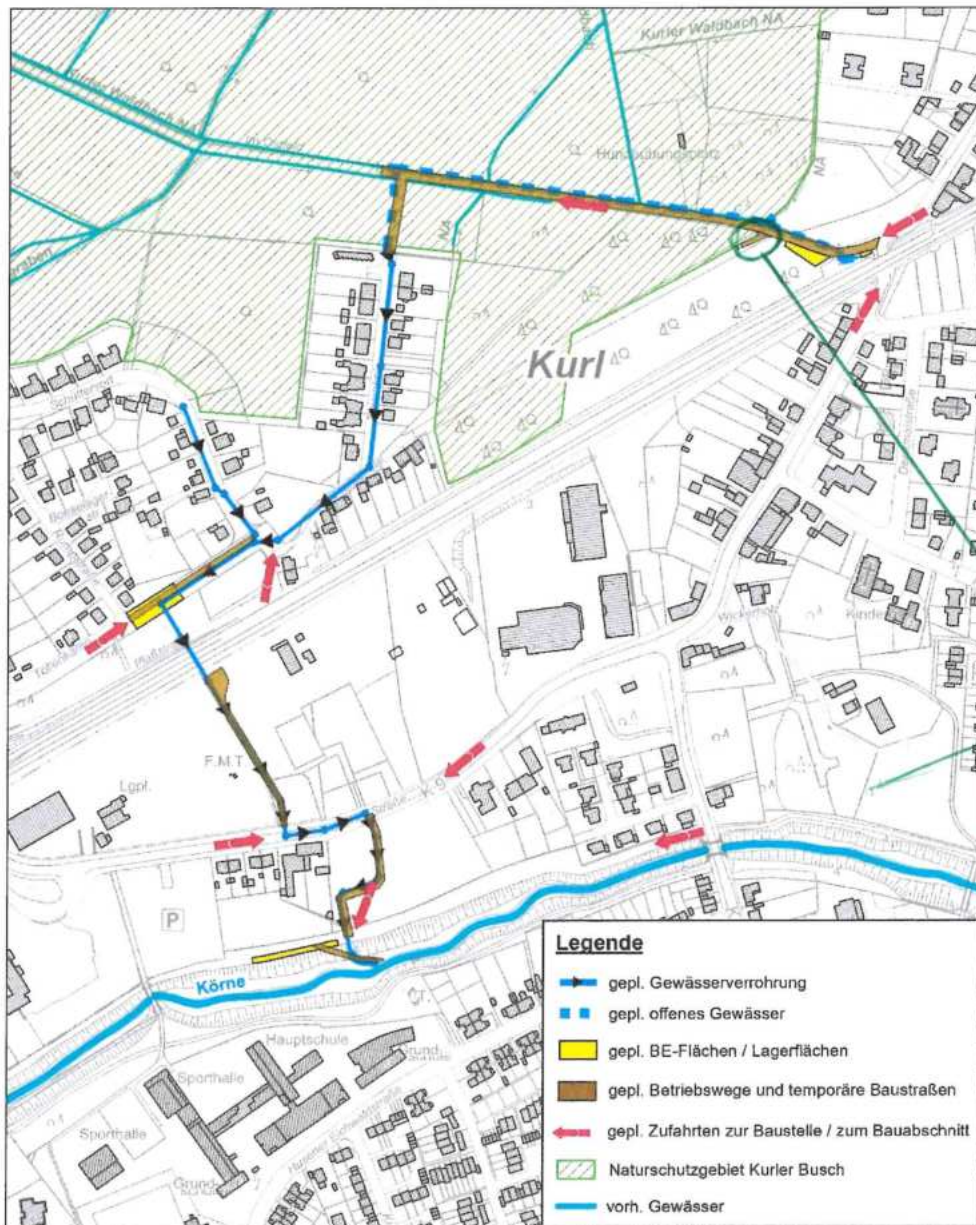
gepl. Betriebswege, temporäre Baustraßen, Baustellenzufahrten, BE- und Lagerflächen
